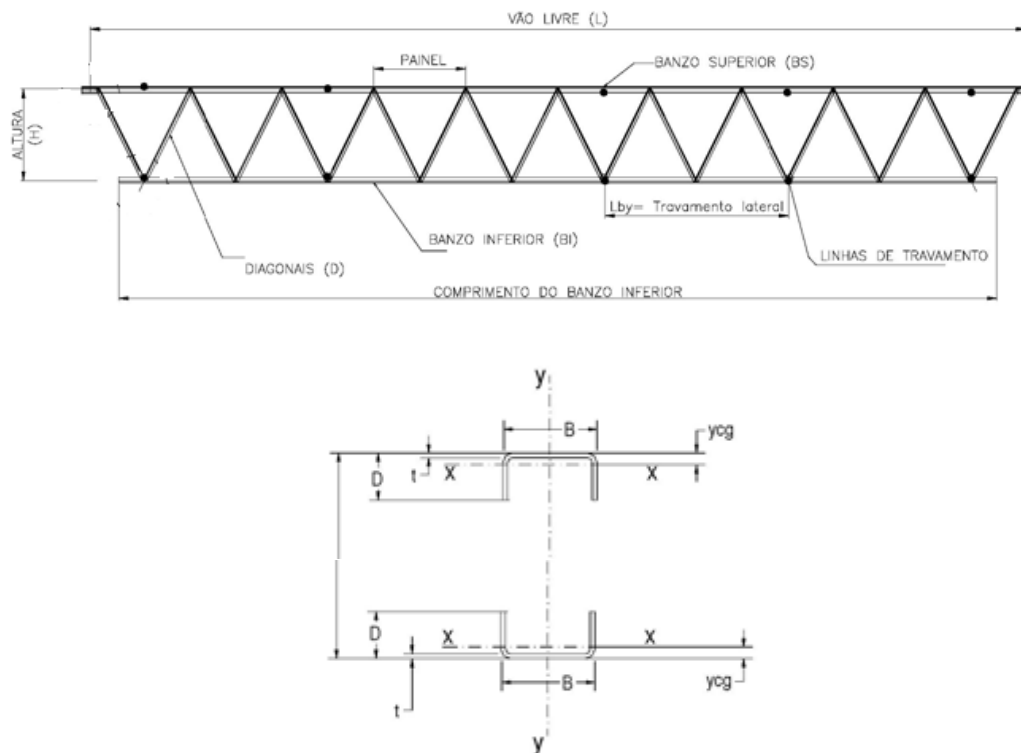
Treliça Tipo Steel Joist “U” (Adaptado de D’Alambert, 2007)
